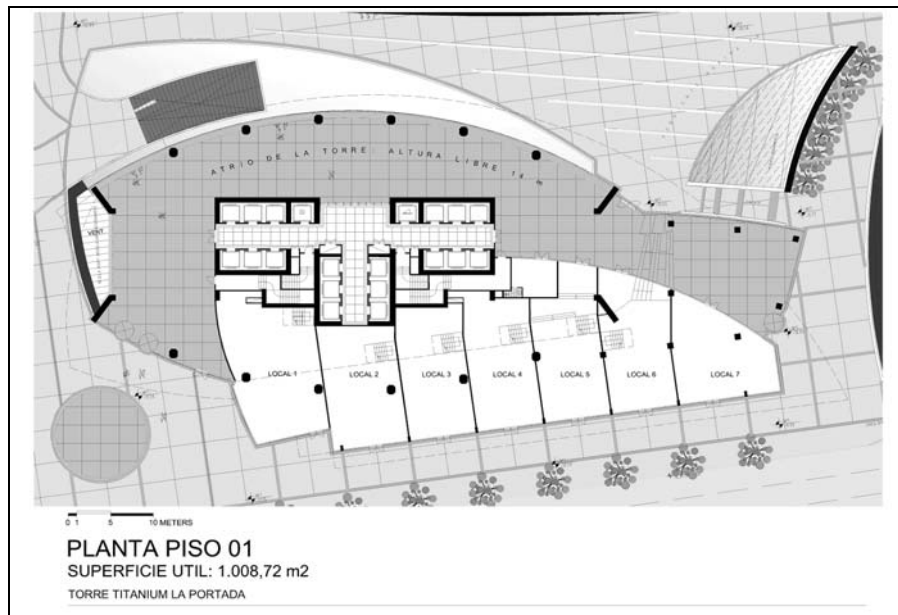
4. Planta Primer Piso. Planos Arquitectura. Fuente: ASL Sencorp.
